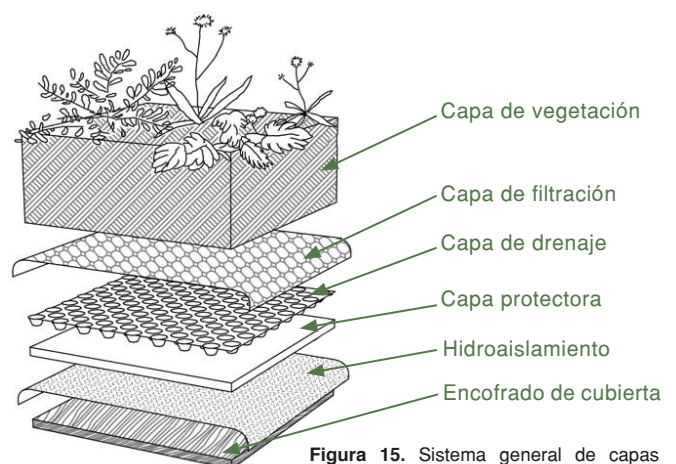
Sistema general de capas de una cubierta verde. Fuente: Pin-Up Houses.
